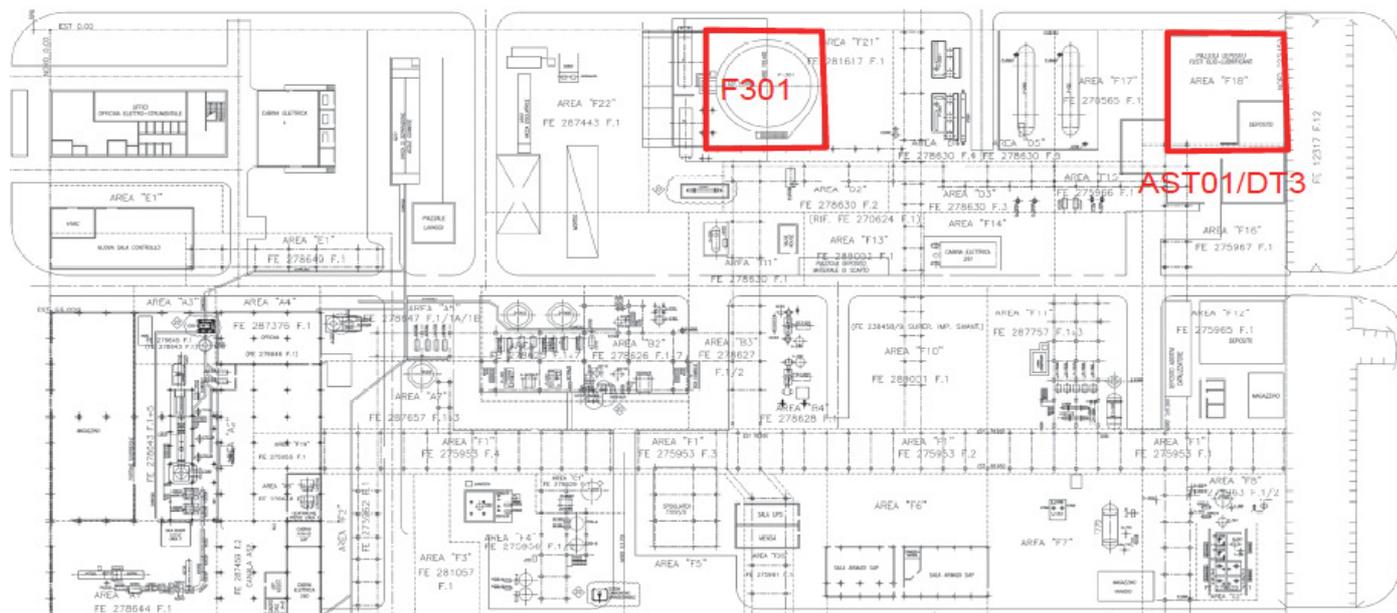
Planimetria Deposito Temporaneo AST01/DT3 e Gasometro F301
